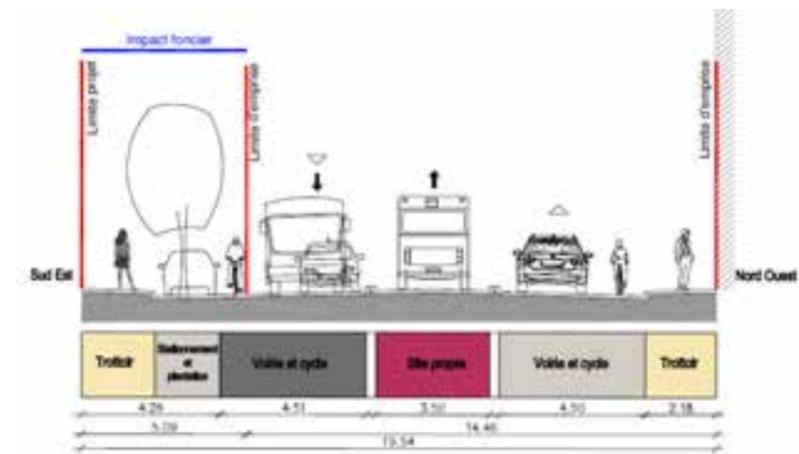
Coupe type en section courante sur la rue Danielle Casanova
